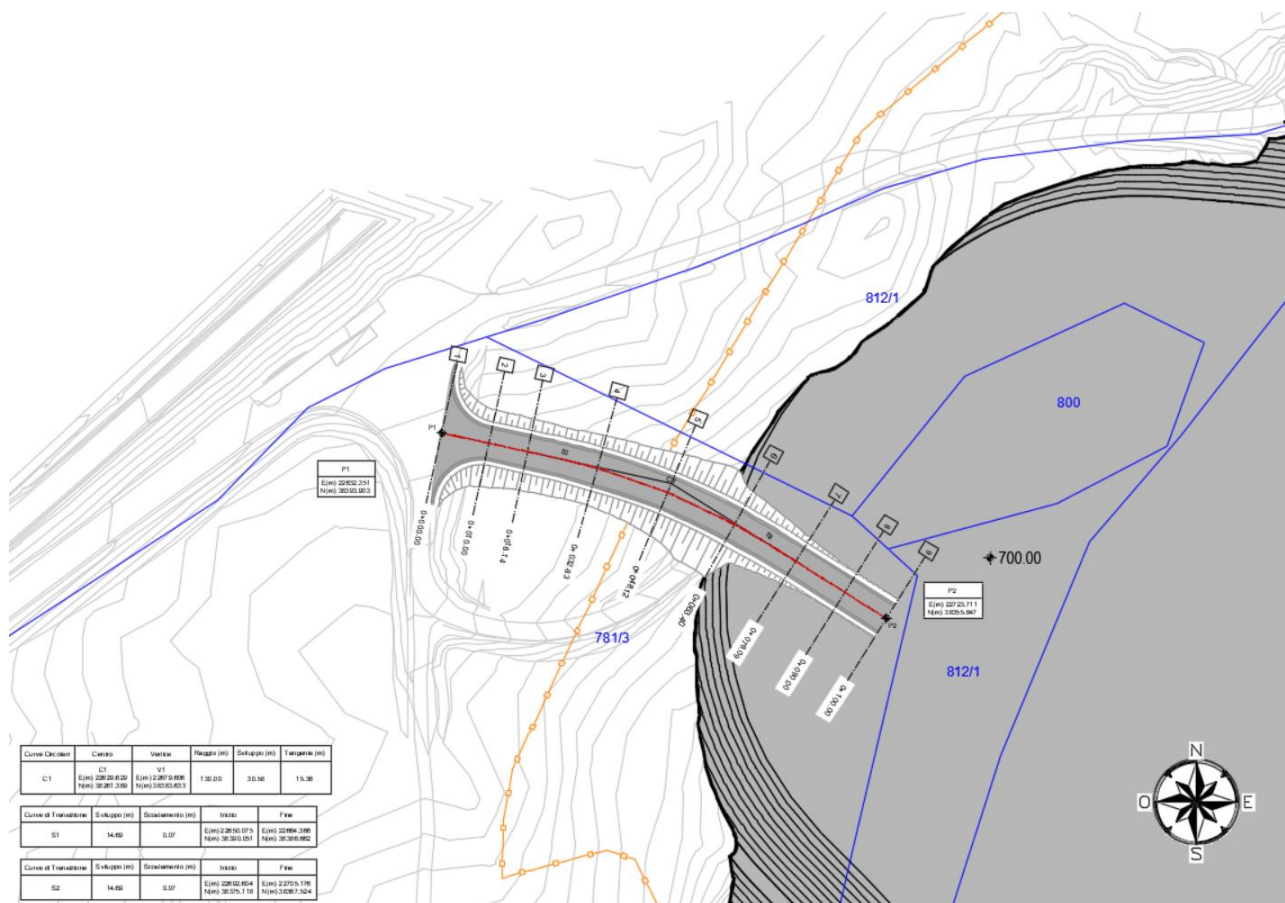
Planimetria d'intervento del deposito principale e della viabilità di collegamento alla parte sommitale a quota 700 m
